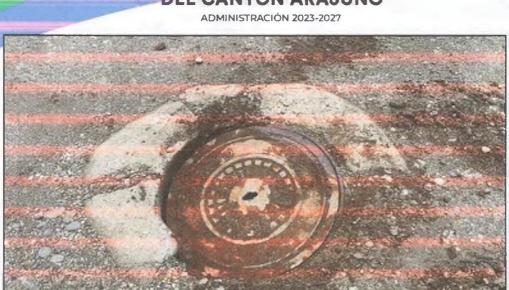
Mal estado en pozo de revisión correspondiente a la red de alcantarillado pluvial, cantón Arajuno.
